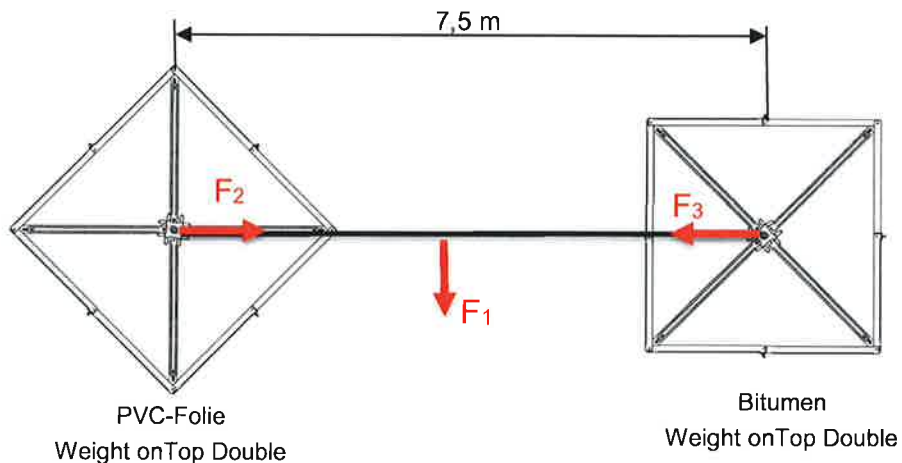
Anschlageinrichtung, Typ: Weight onTop, mit Betonplatten
